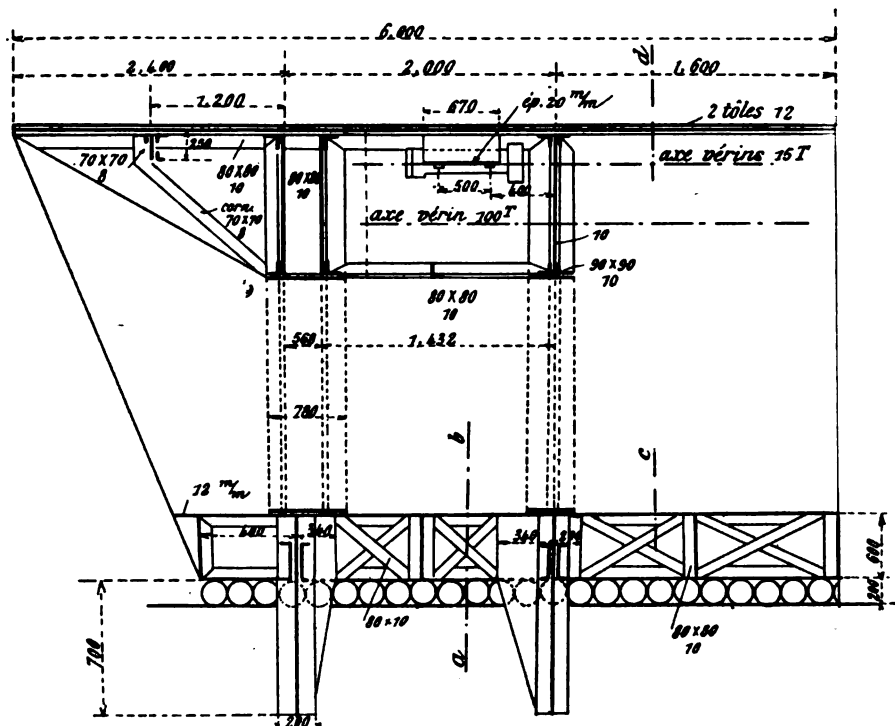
Coupe longitudinale du bouclier (Sully).
